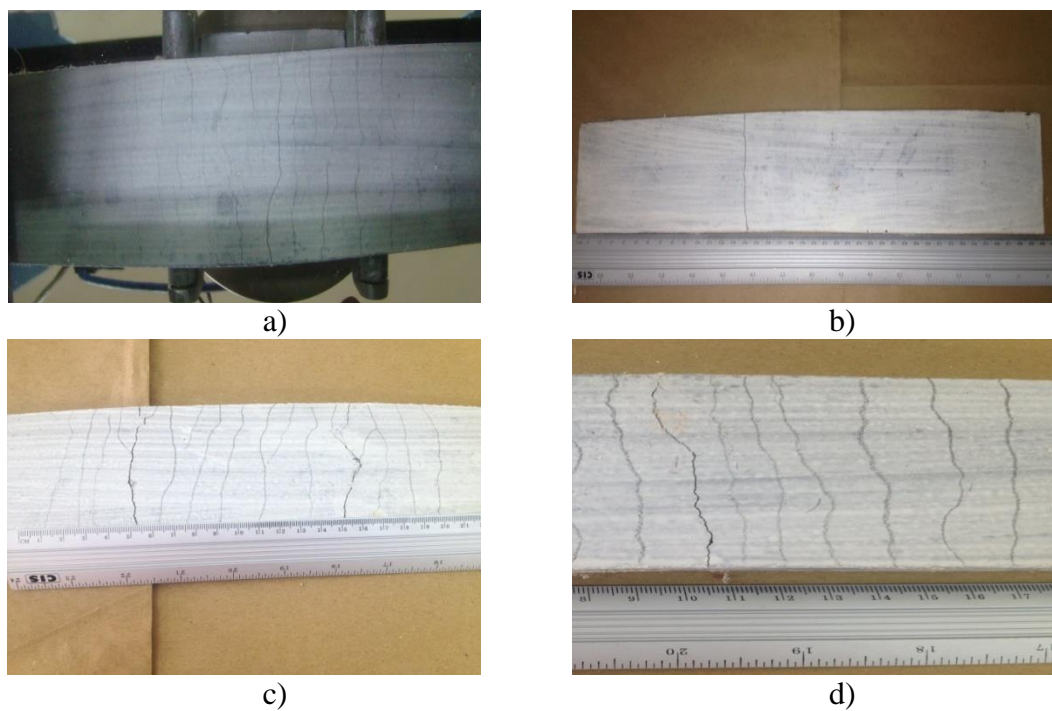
Imagens de amostras após o ensaio de flexão direta: a) Amostras ensaiadas no equipamento e formação das fissuras; b) Após ensaio apenas as fissuras maiores ficavam em evidência; c) Marcação com lápis para melhor visualização da fissura; d) Detalhe das fissuras.
